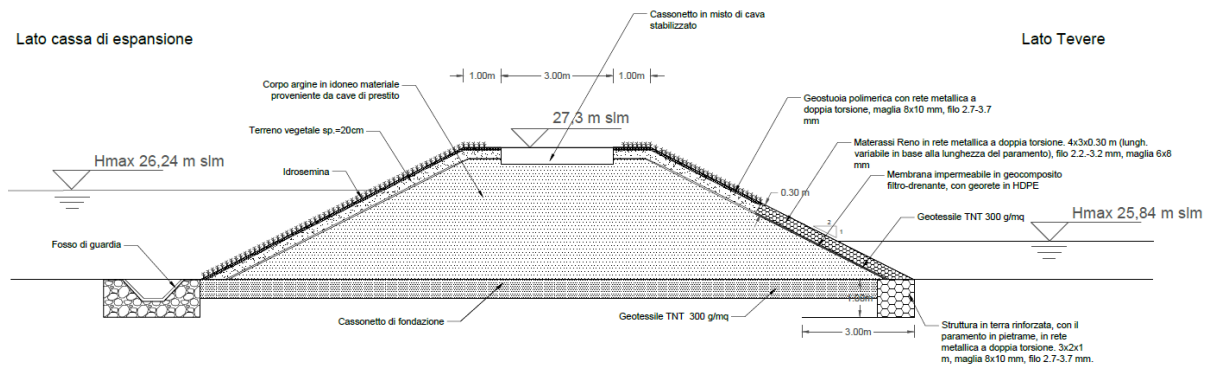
Sezione tipo dell'arginatura della cassa di laminazione di Capena (Elaborato T_21).
